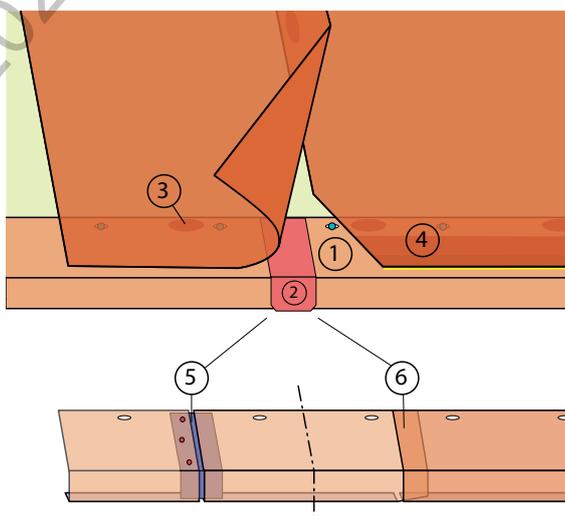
/335: Raccord du lé de sous-couverture soudé; bavette revêtue avec fixation par trous oblongs (1), joint longitudinal soudé par-dessus le morceau de lé de sous-couverture (2), fixation du lé de sous-couverture par soudure ponctuelle (3) soudure terminée (4) avec cordon de soudure sortant (jaune).
